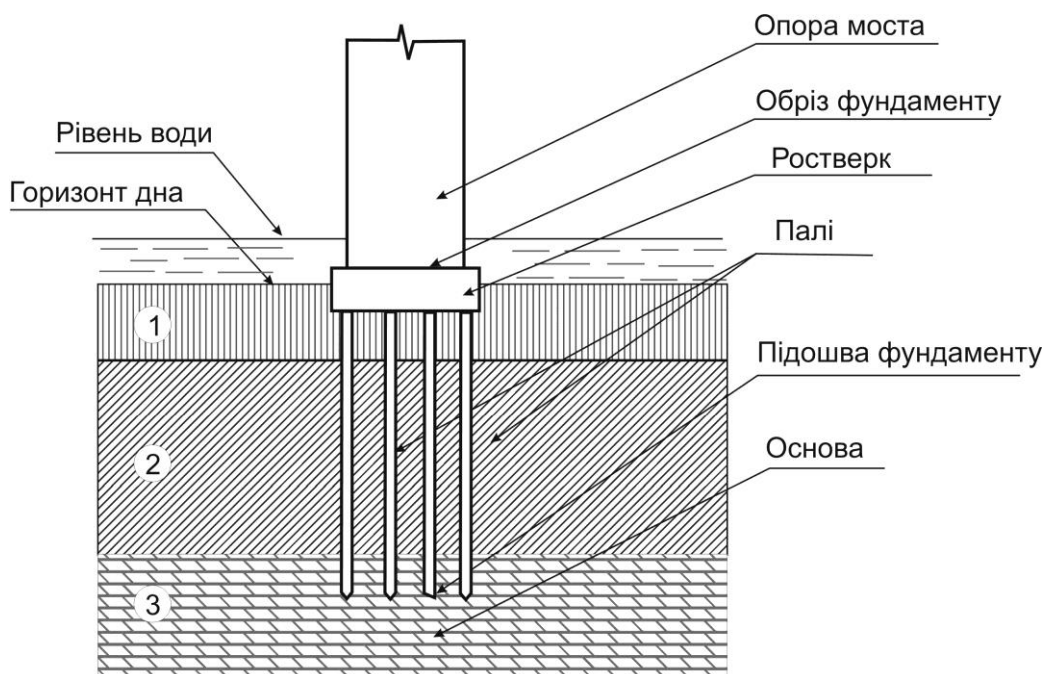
Пальовий фундамент з низьким ростверком на акваторії
